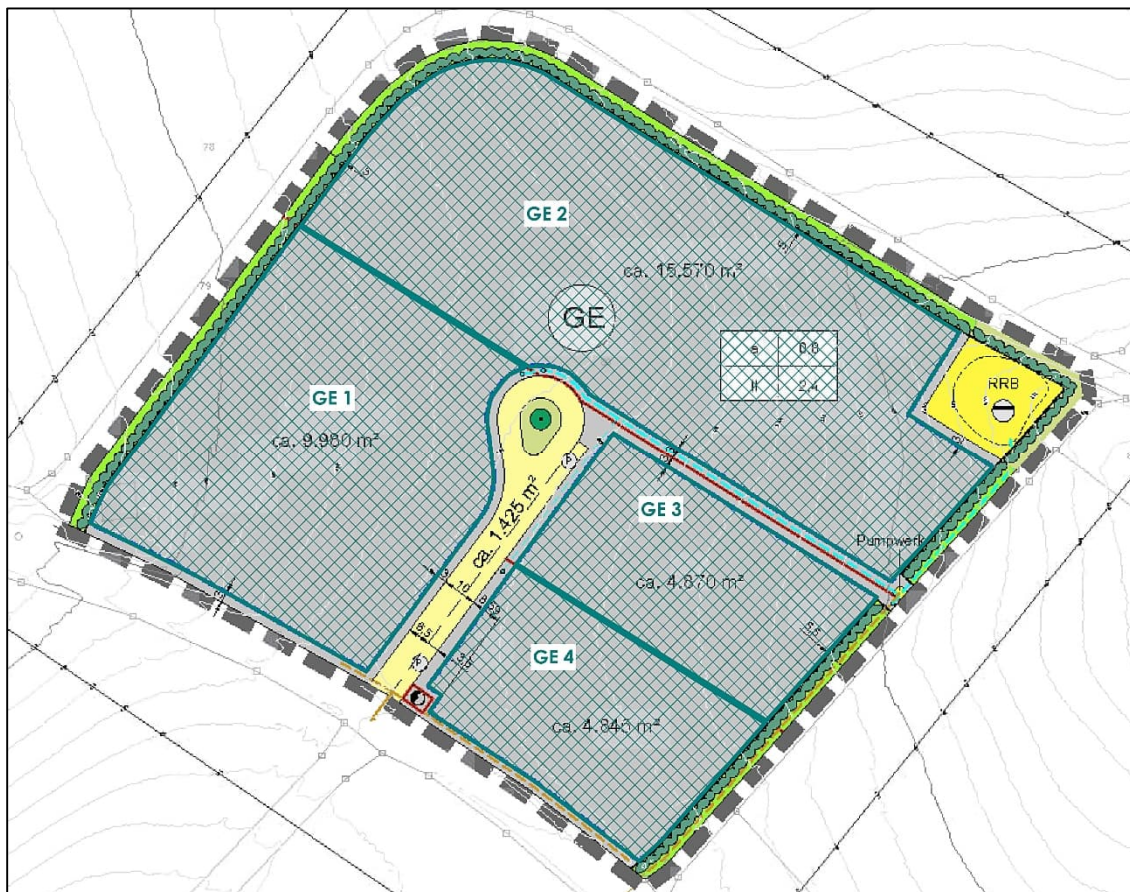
Lageplan mit Darstellung der Emissionsbezugsflächen
